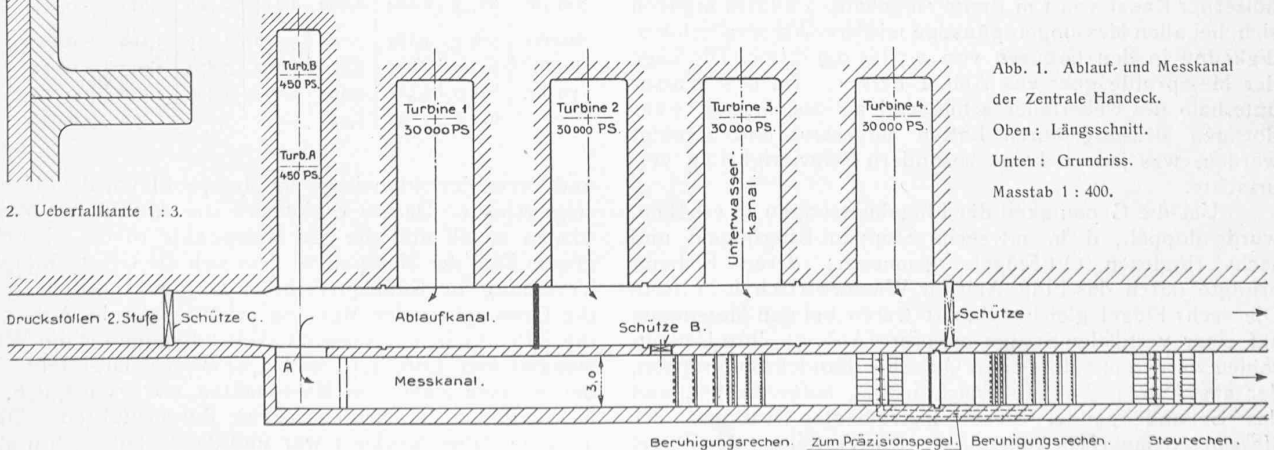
Ablauf- und Messkanal der Zentrale Handeck. Oben: Längsschnitt. Unten: Grundriss. Masstab 1:400.
